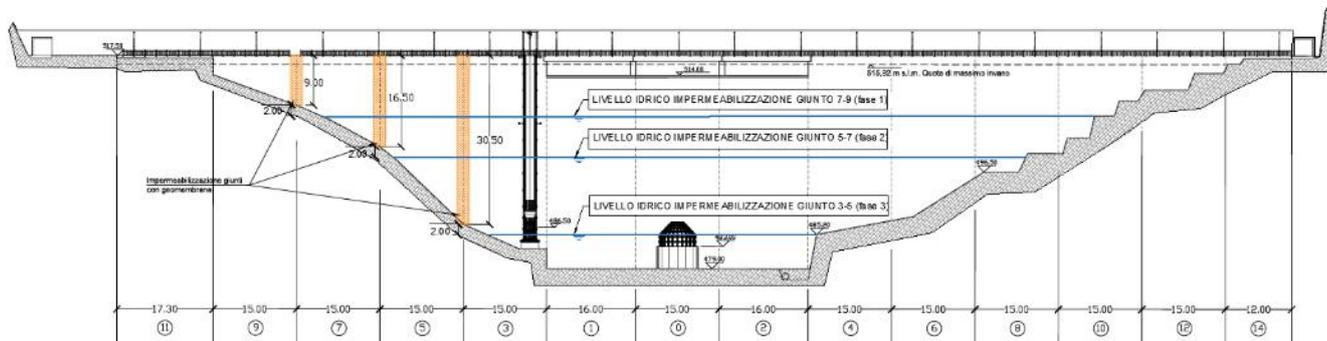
Planimetria riassuntiva delle fasi di intervento di impermeabilizzazione dei giunti
